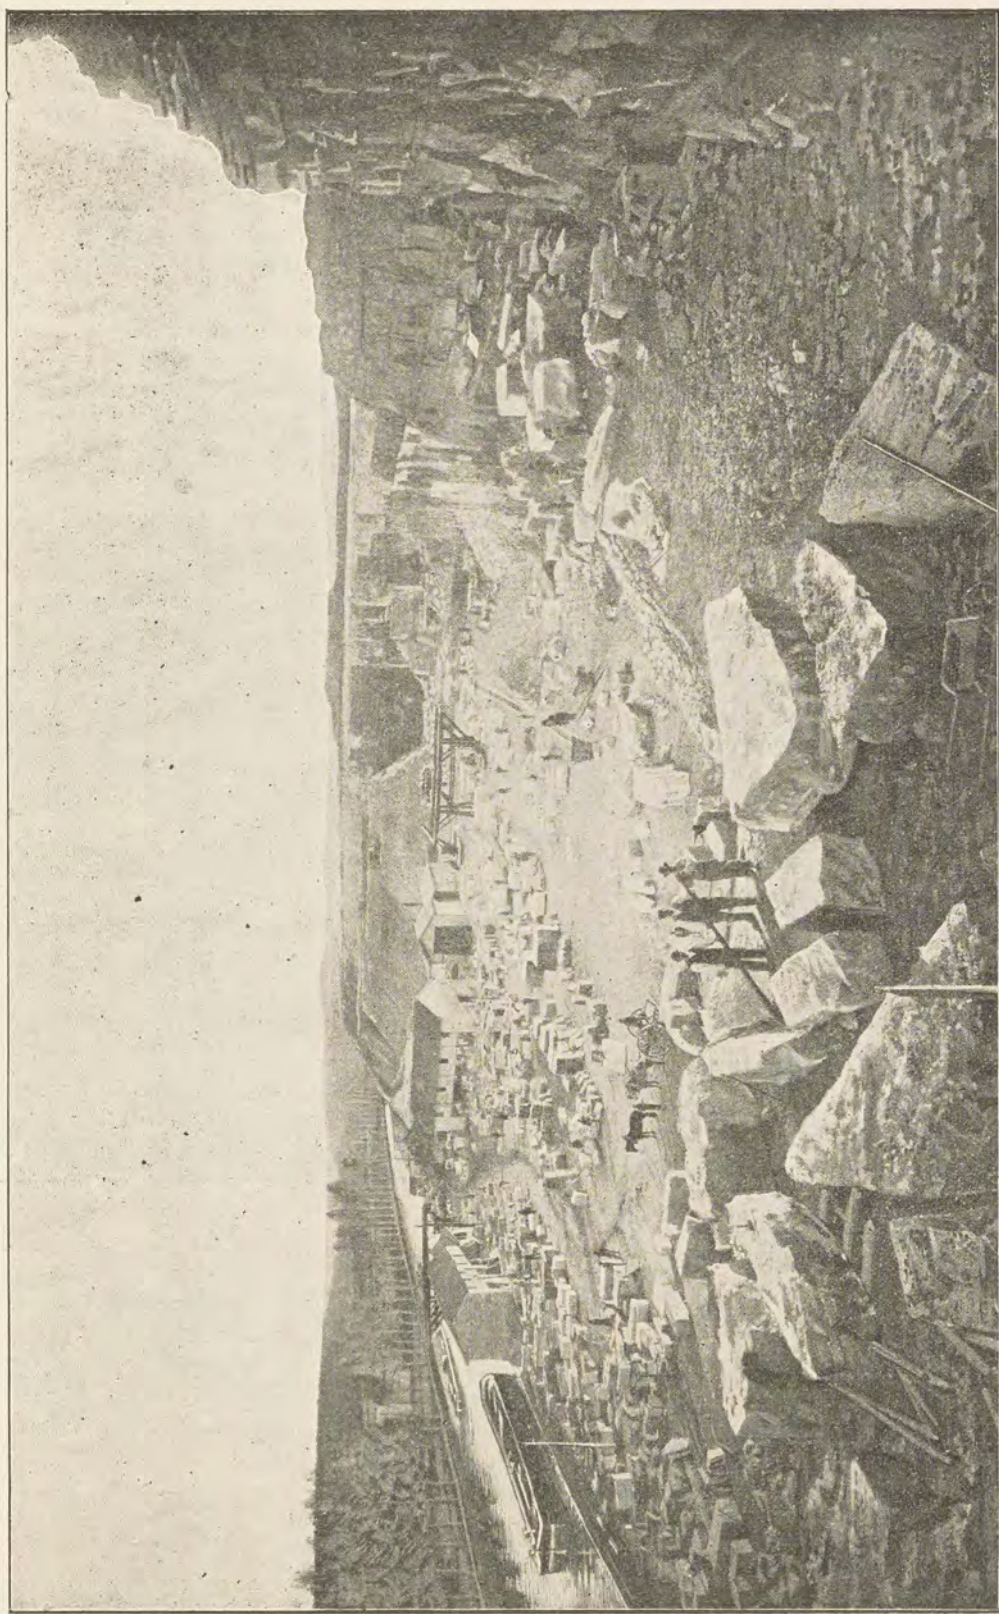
Carrière de Chassignelles (Yonne), exploitée par MM. Fèvre et C^e (Société des carrières et scieries à pierre de Bourgogne).
